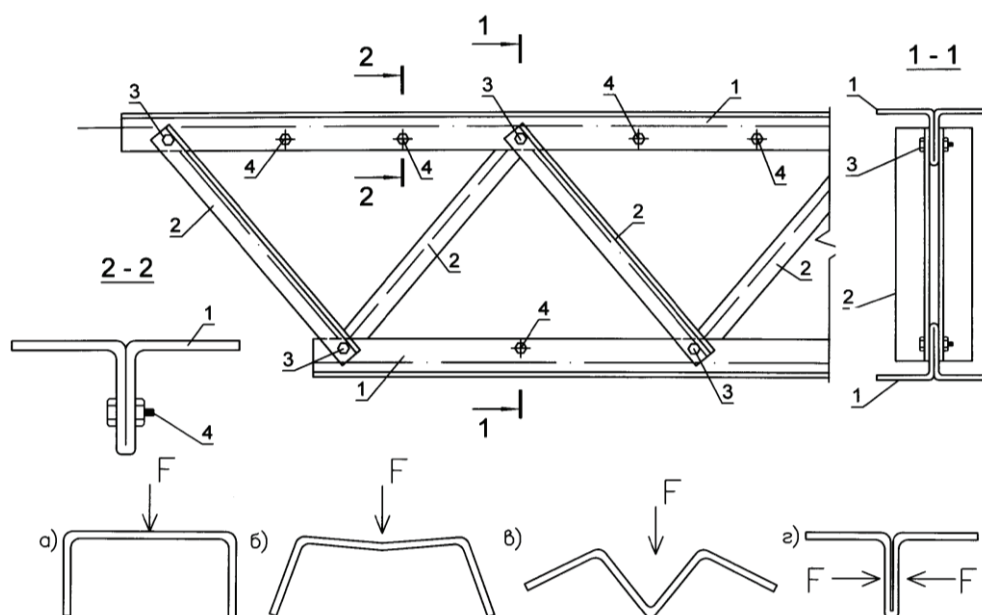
Схемы фермы с поясами из гнутых тавров с двойными стенками и решеткой из одиночных уголков: 1 – стержни поясов; 2 – стержни решетки; 3 – болтовые соединения стержней поясов и решетки; 4 – болтовые соединения стержней поясов; а, б, в, г – очередность операций по изготовлению поясного стержня
